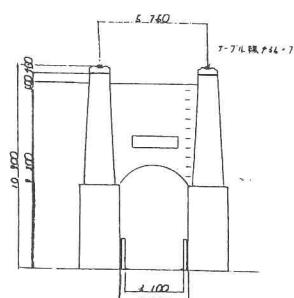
美濃橋、鉄筋コンクリート塔柱図。¹¹⁾
